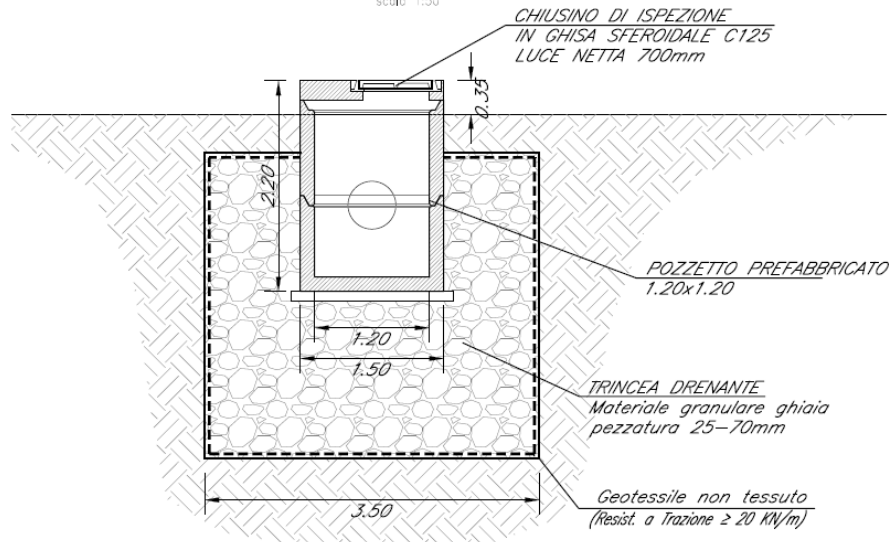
Trincea Drenante – Sezione tipo Pozzetto di ispezione
